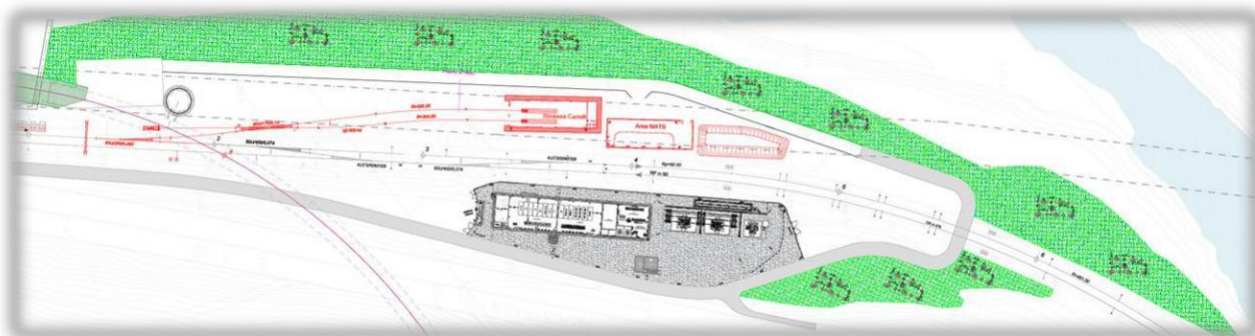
Opere a verde – Planimetria di progetto Ponte Gardena.
